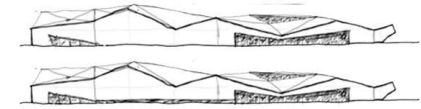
Bocetos evolución alzado elaborado por Álvaro Fernandes Andrade
